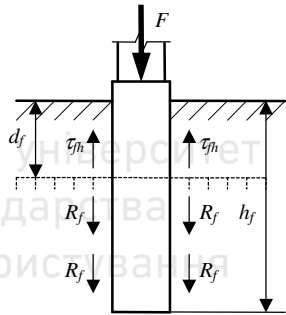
Схема дії на фундамент сил при промерзанні ґрунту
